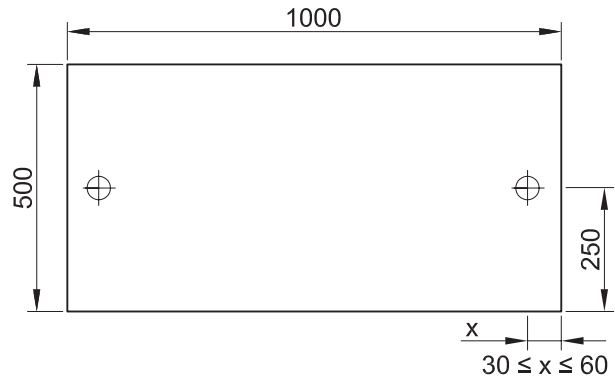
Colocación de las fijaciones en elementos verticales.
